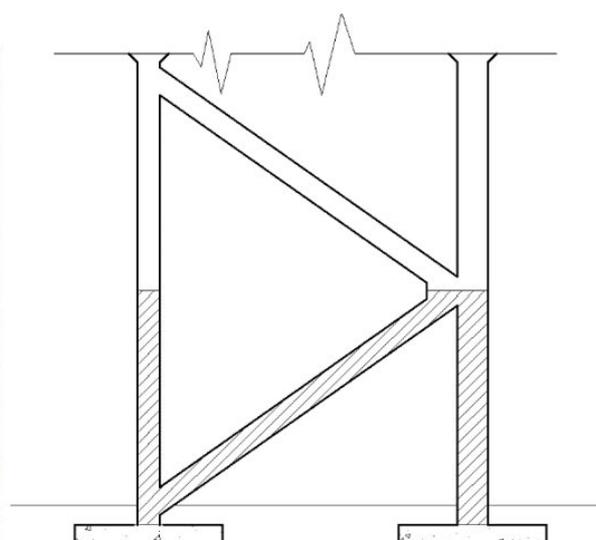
Betonagem da primeira fase (Contraventamentos em betão armado)
